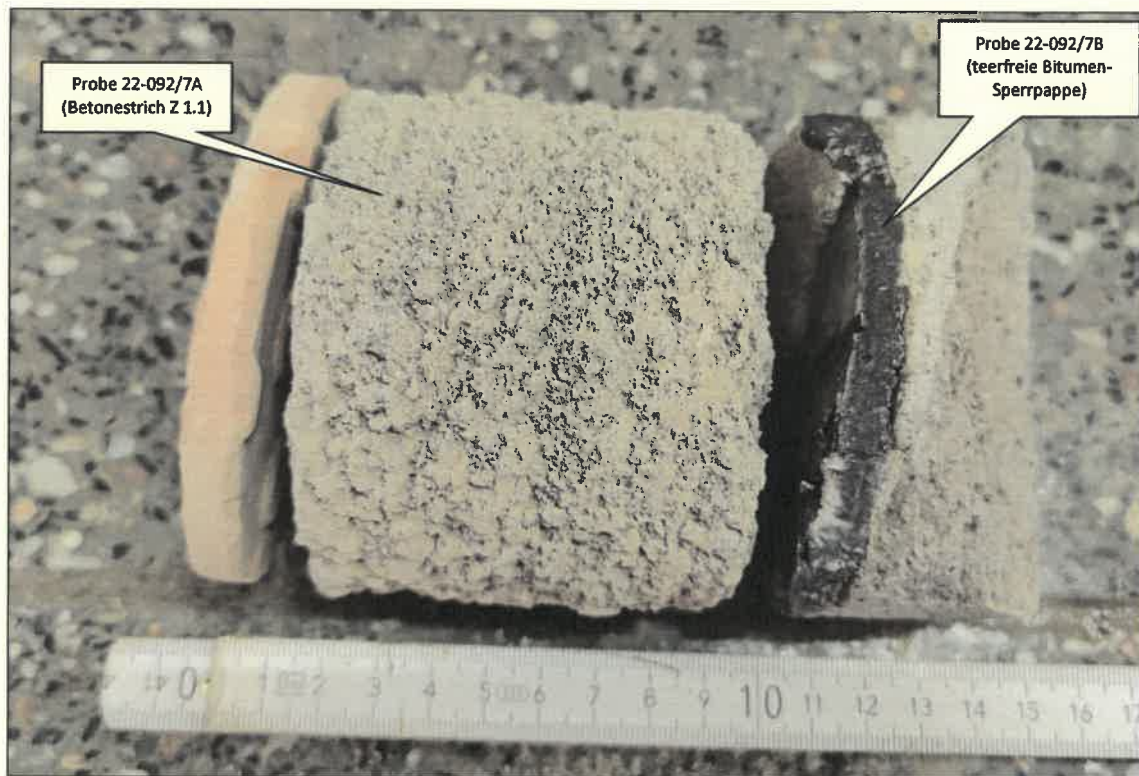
Anbau NE, WC Damen R 126 – Kernbohrung 22-092/7 zeigt Fußboden-
